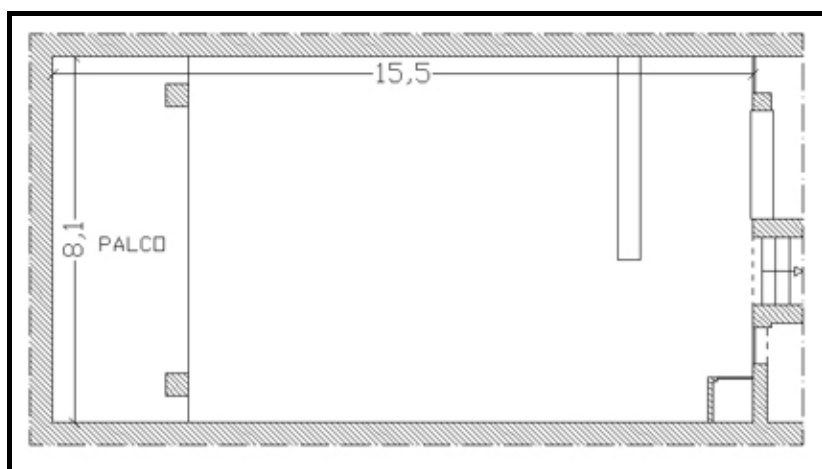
Planta do Bar-Concerto Tertúlia Castelêense
